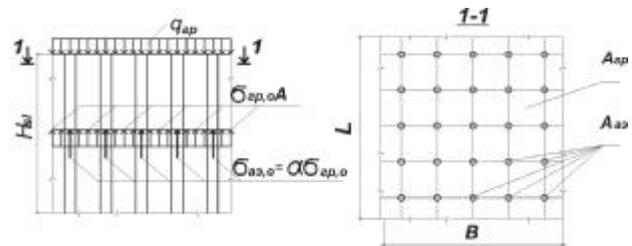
Расчетная схема армированного просадочного грунта, при $W < W_{sl}$
